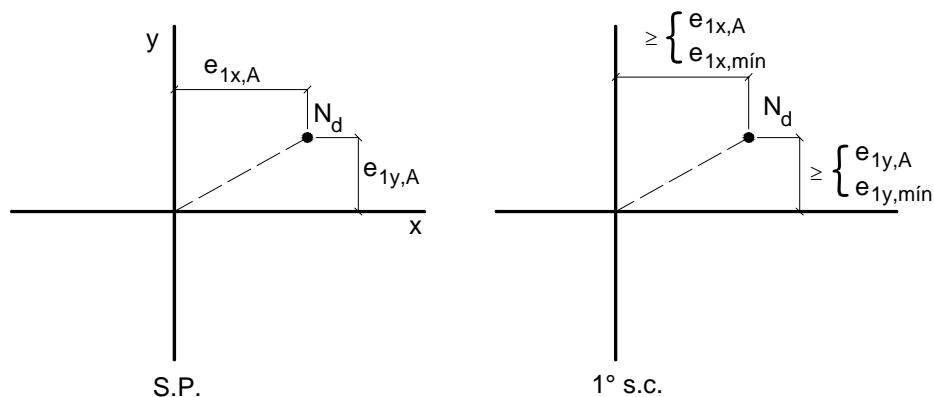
Situação de projeto e de cálculo para as seções de extremidade dos pilares de canto.
